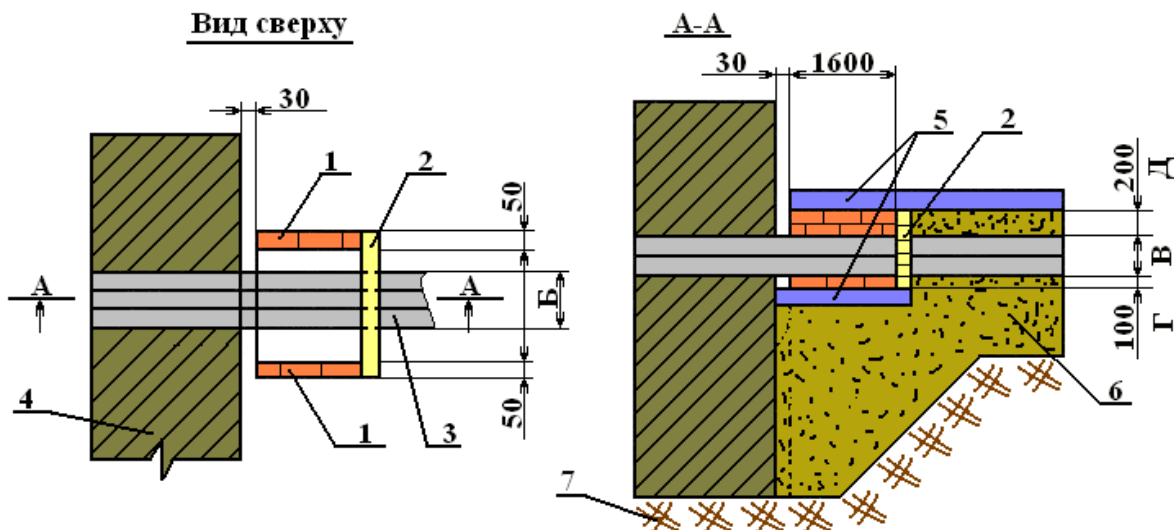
Защита блока труб от среза и смятия при выходе из фундамента в грунт: 1 – кирпичная кладка, 2 – антисептированные доски толщиной 50 мм, 3 – блок труб, 4 – фундамент под оборудование, 5 – сборные железобетонные плиты, 6 – насыпной уплотненный грунт, 7 – грунт основания; Б – ширина блока труб; В – высота блока труб; Г и Д зазоры, определяемые величиной усадки грунта
